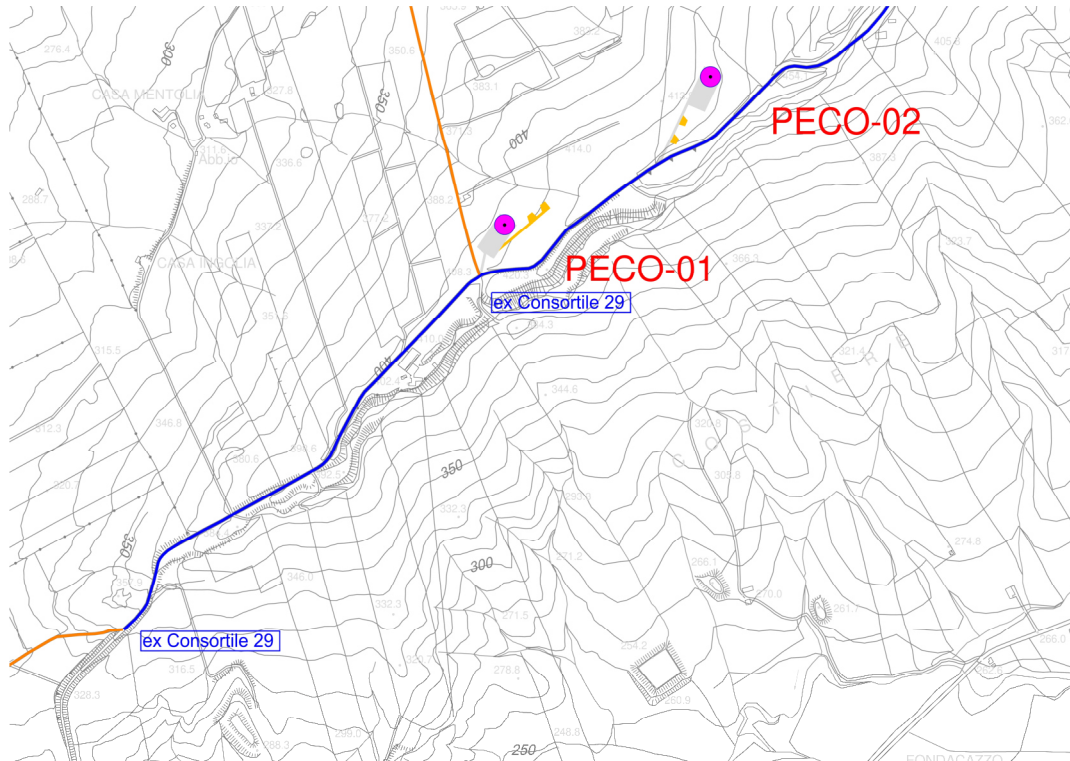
Planimetria delle strade di cantiere scala 1:5.000
